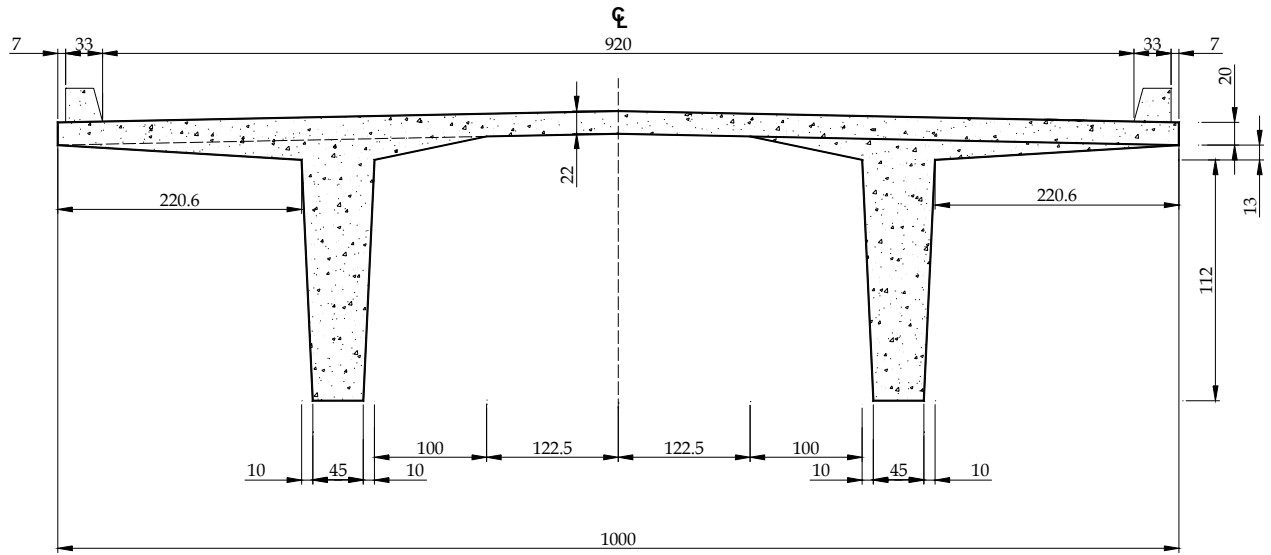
Sección transversal de la superestructura con nervaduras. Proyecto tipo, longitud del claro 15 m
